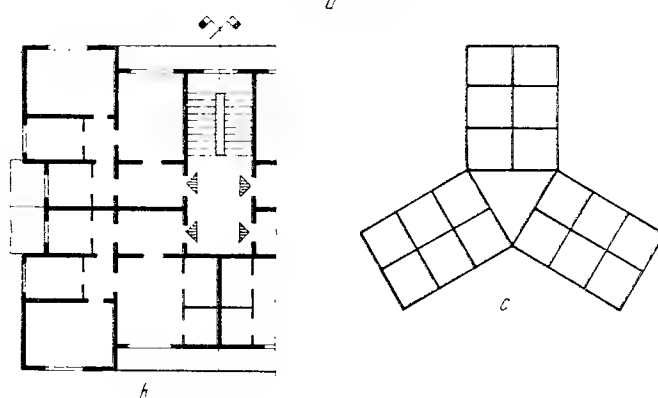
Structuri de rezistență din diafragme de beton armat monolit :
